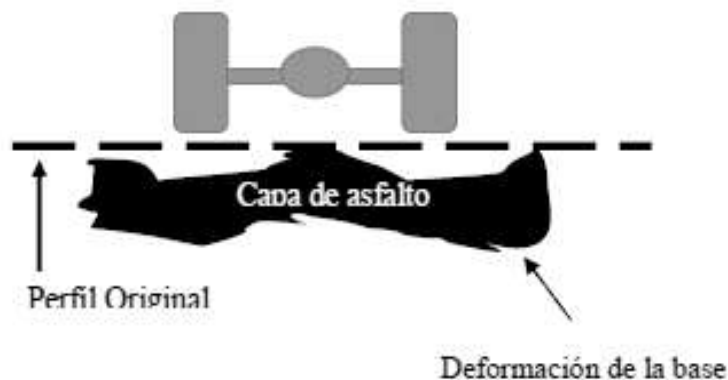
Deformación permanente de un pavimento asfáltico
